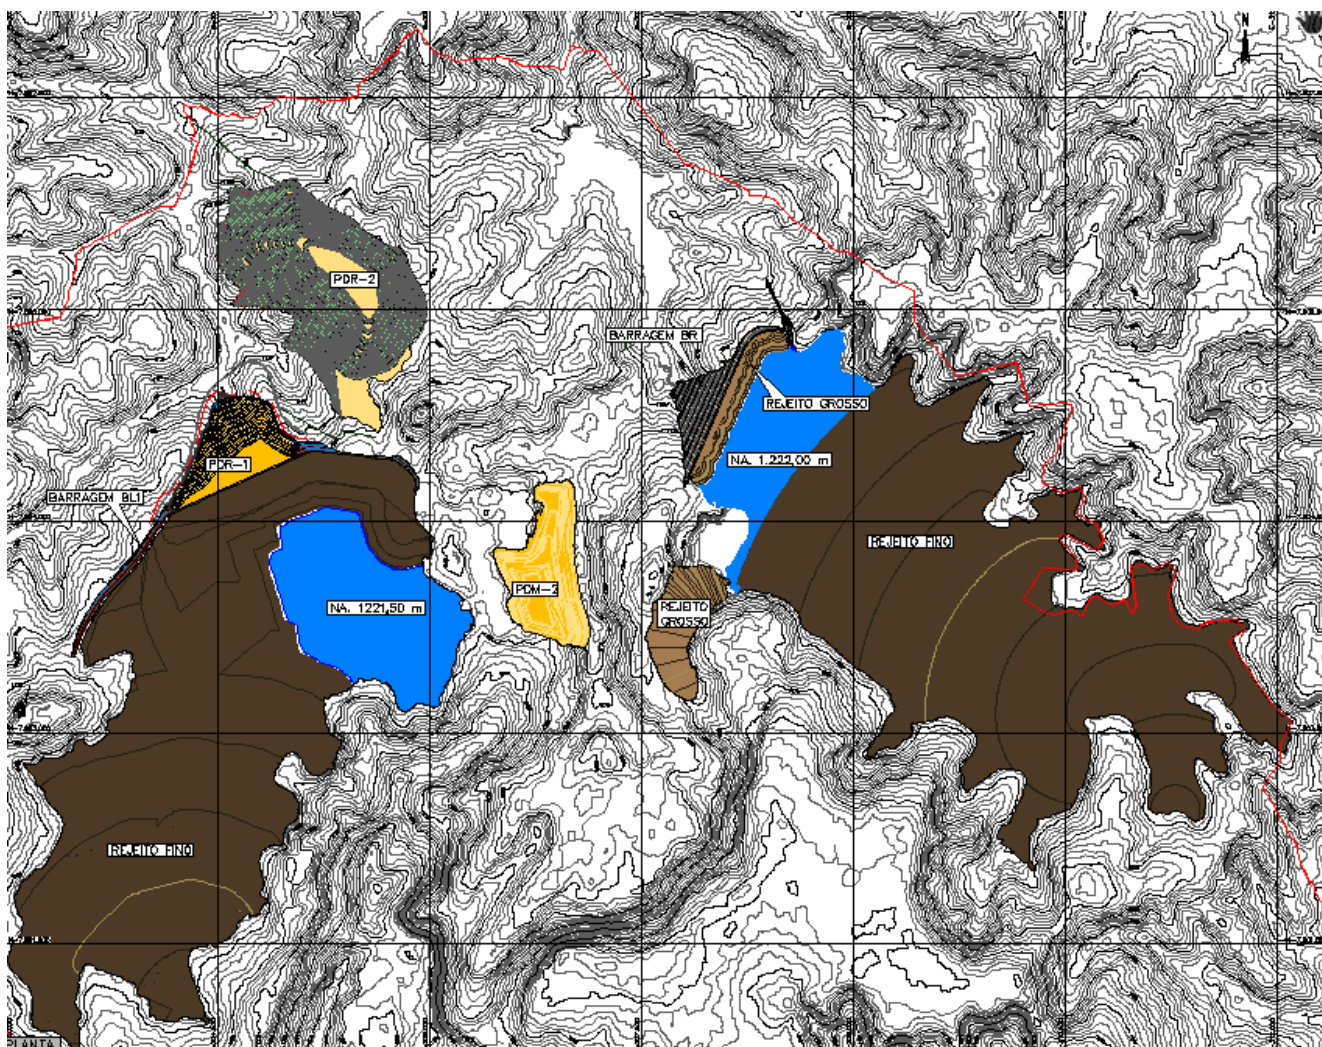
Estruturas previstas no Plano Diretor De Tapira – CMT.
